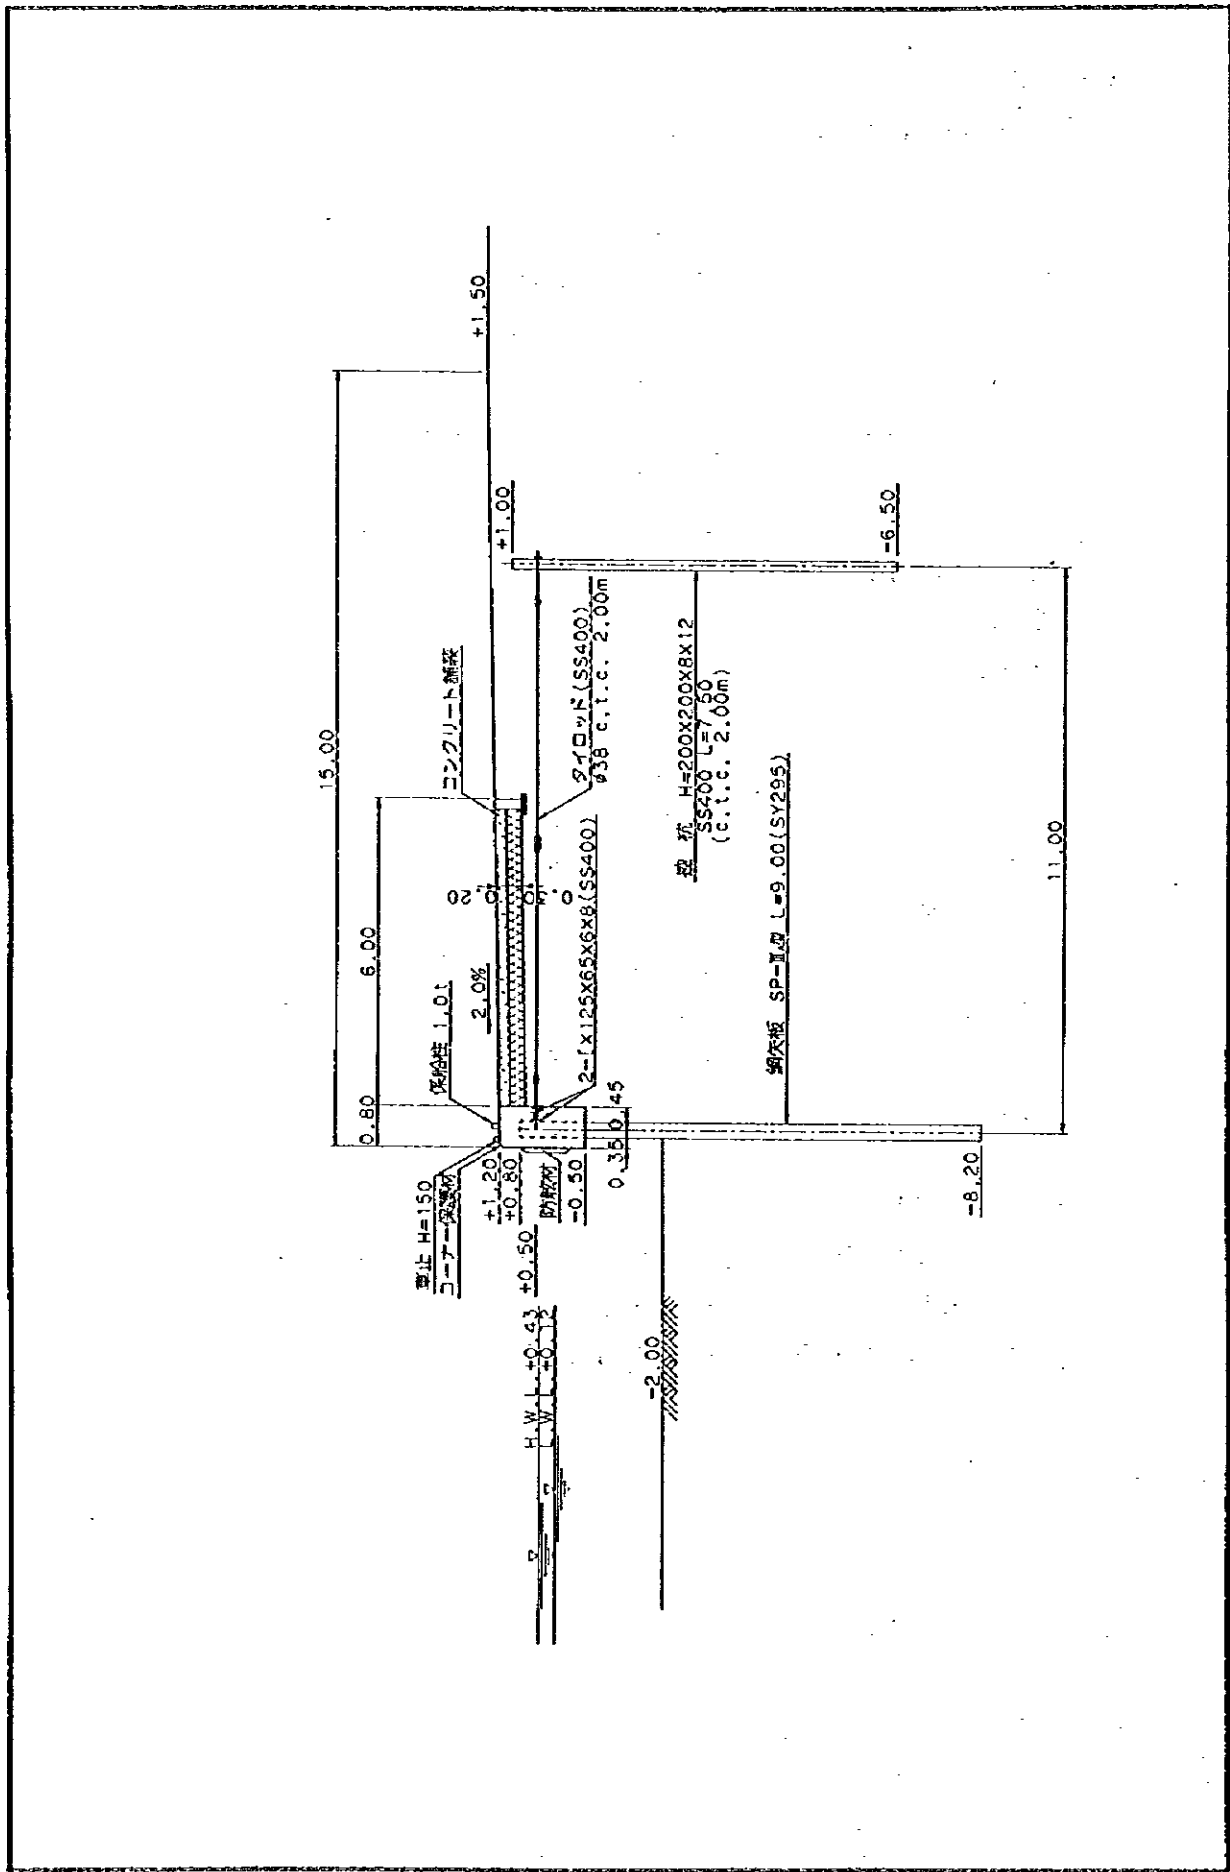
水揚岸壁 (-2m) 標準断面図
